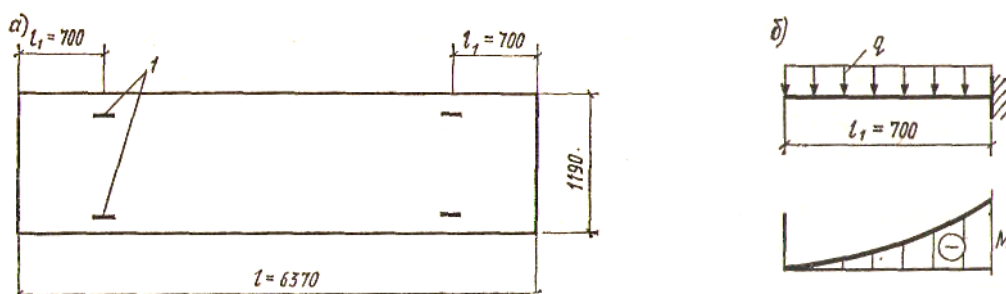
К расчету сборной панели перекрытия на монтажную нагрузку
